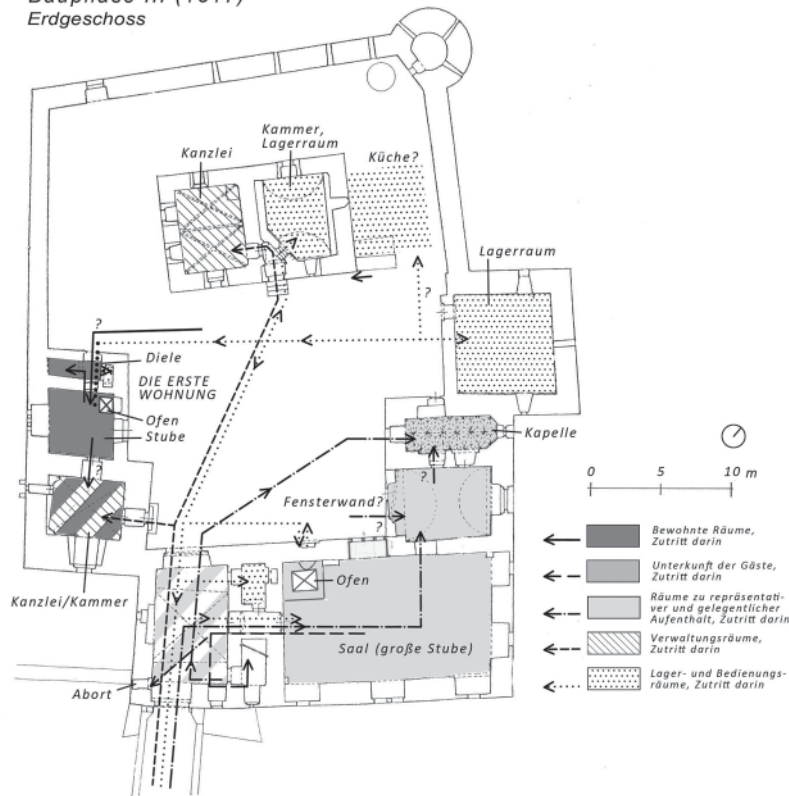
Funktionsschema nach dem Umbau in Bauphase III, Erdgeschoss (Plan: M. Rykl; Digitalisierung: O. Hubert und D. Čermák).
